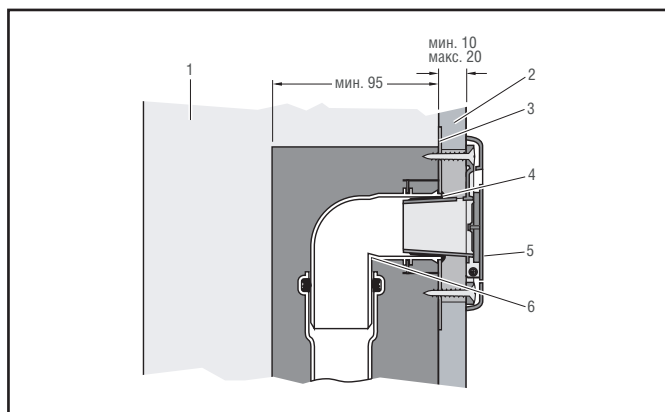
Монтаж в легких стеновых конструкциях. Вариант 2.
